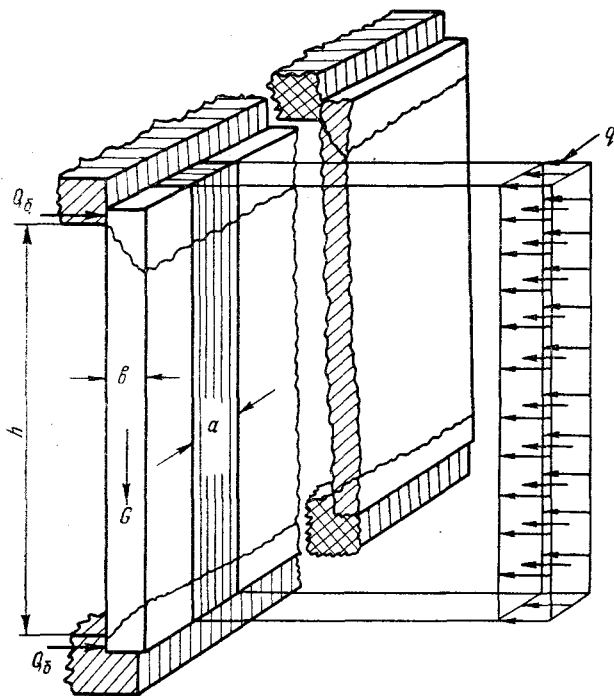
Схема к расчету опоры-стенки на устойчивость (G — вес опоры-стенки).
